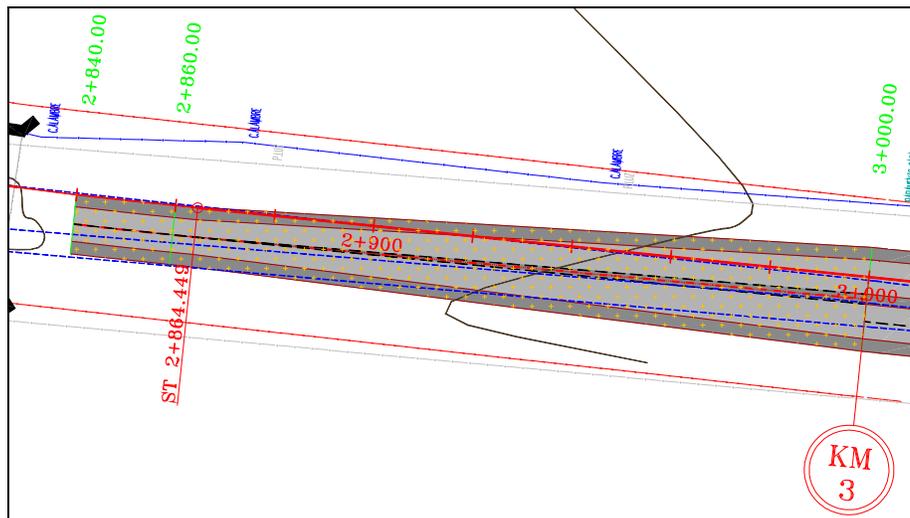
Plano de planta del proyecto de liga del km2+840 al 3+300.
